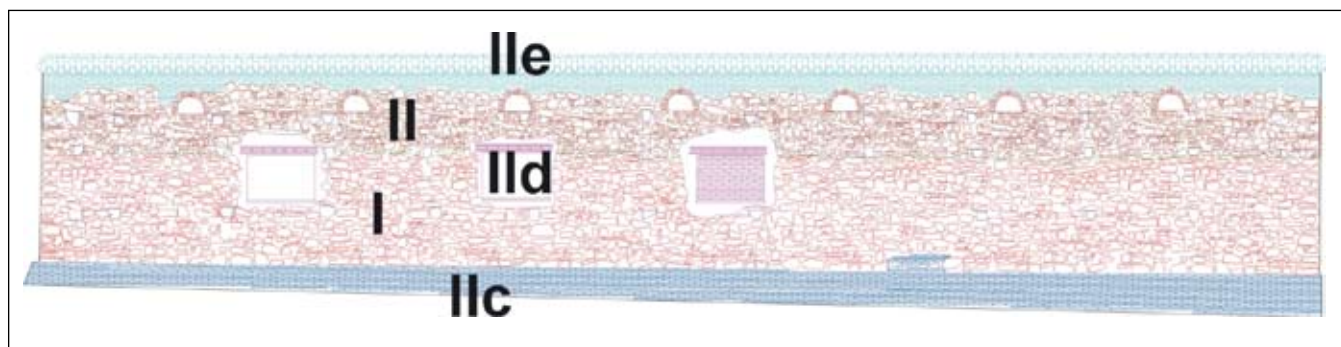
Figura II. Levantamiento del alzado del exterior del muro E, con las fases constructivas principales señaladas.
